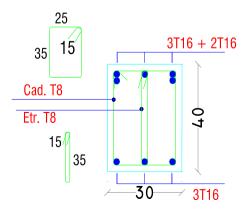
Ferraillage des poutres principales pour Etage 9.
